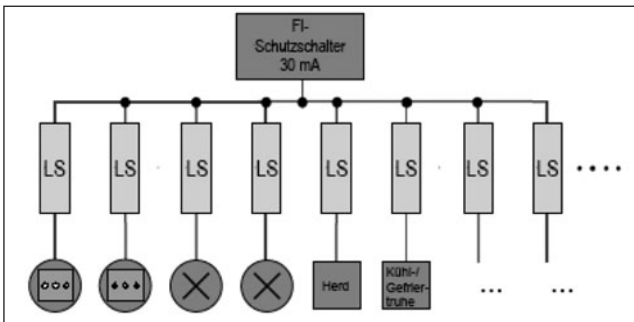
Installation mit zentralem FI-Schutzschalter und LS-Schaltern für Abzweige
